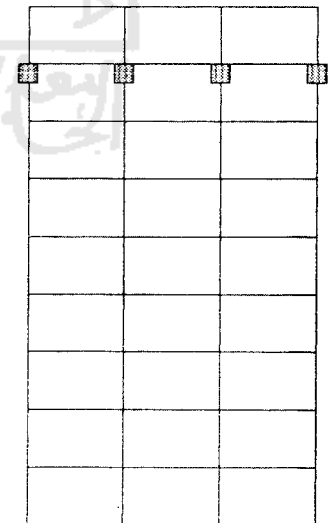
Tingkat 9 lantai ke 5
